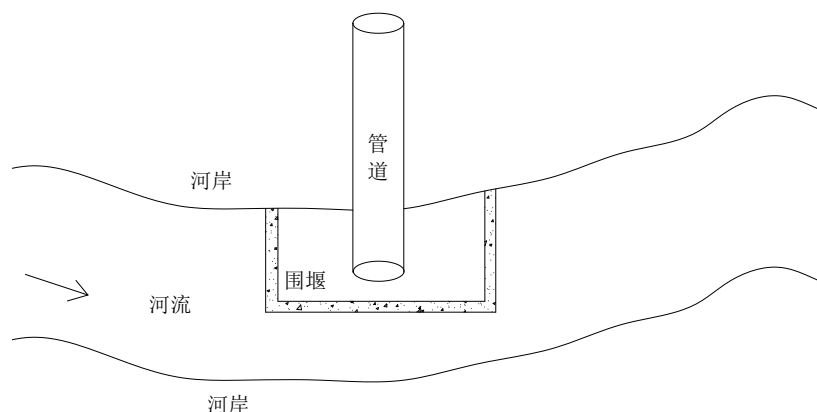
围堰导流穿越河流施工断面示意图
